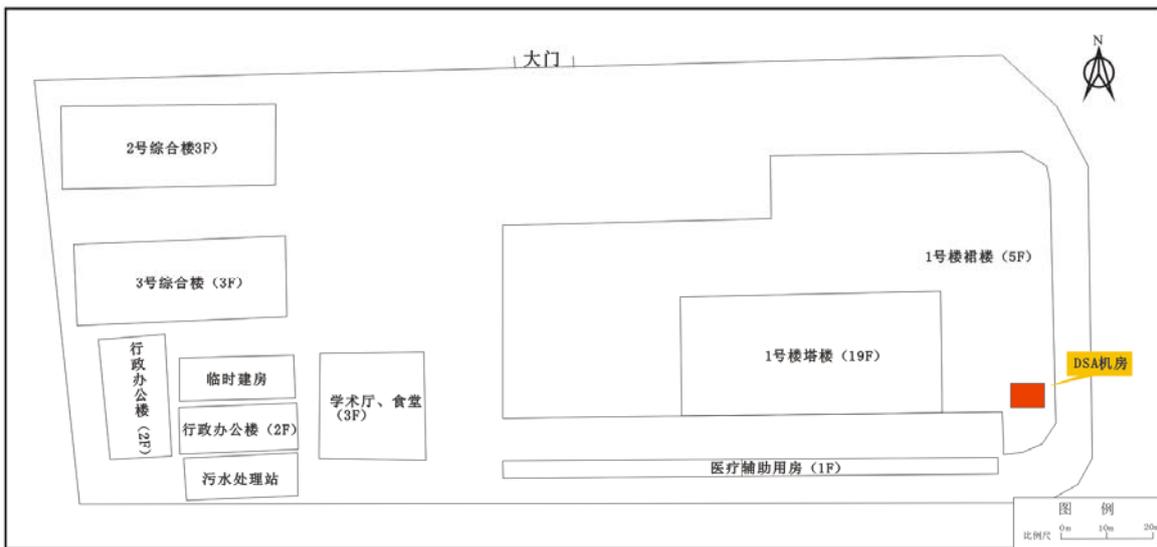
汉中铁路中心医院总平面布置及 DSA 机房相对位置关系示意图
